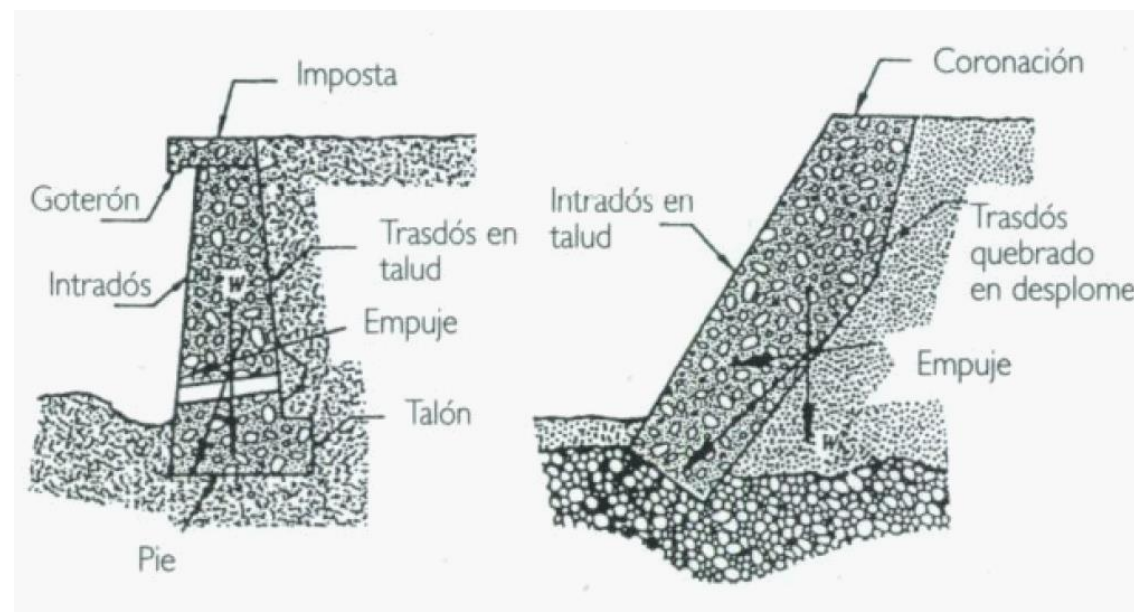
Secciones de muros de gravedad. Fuente: Tipologías de muros de carretera.
